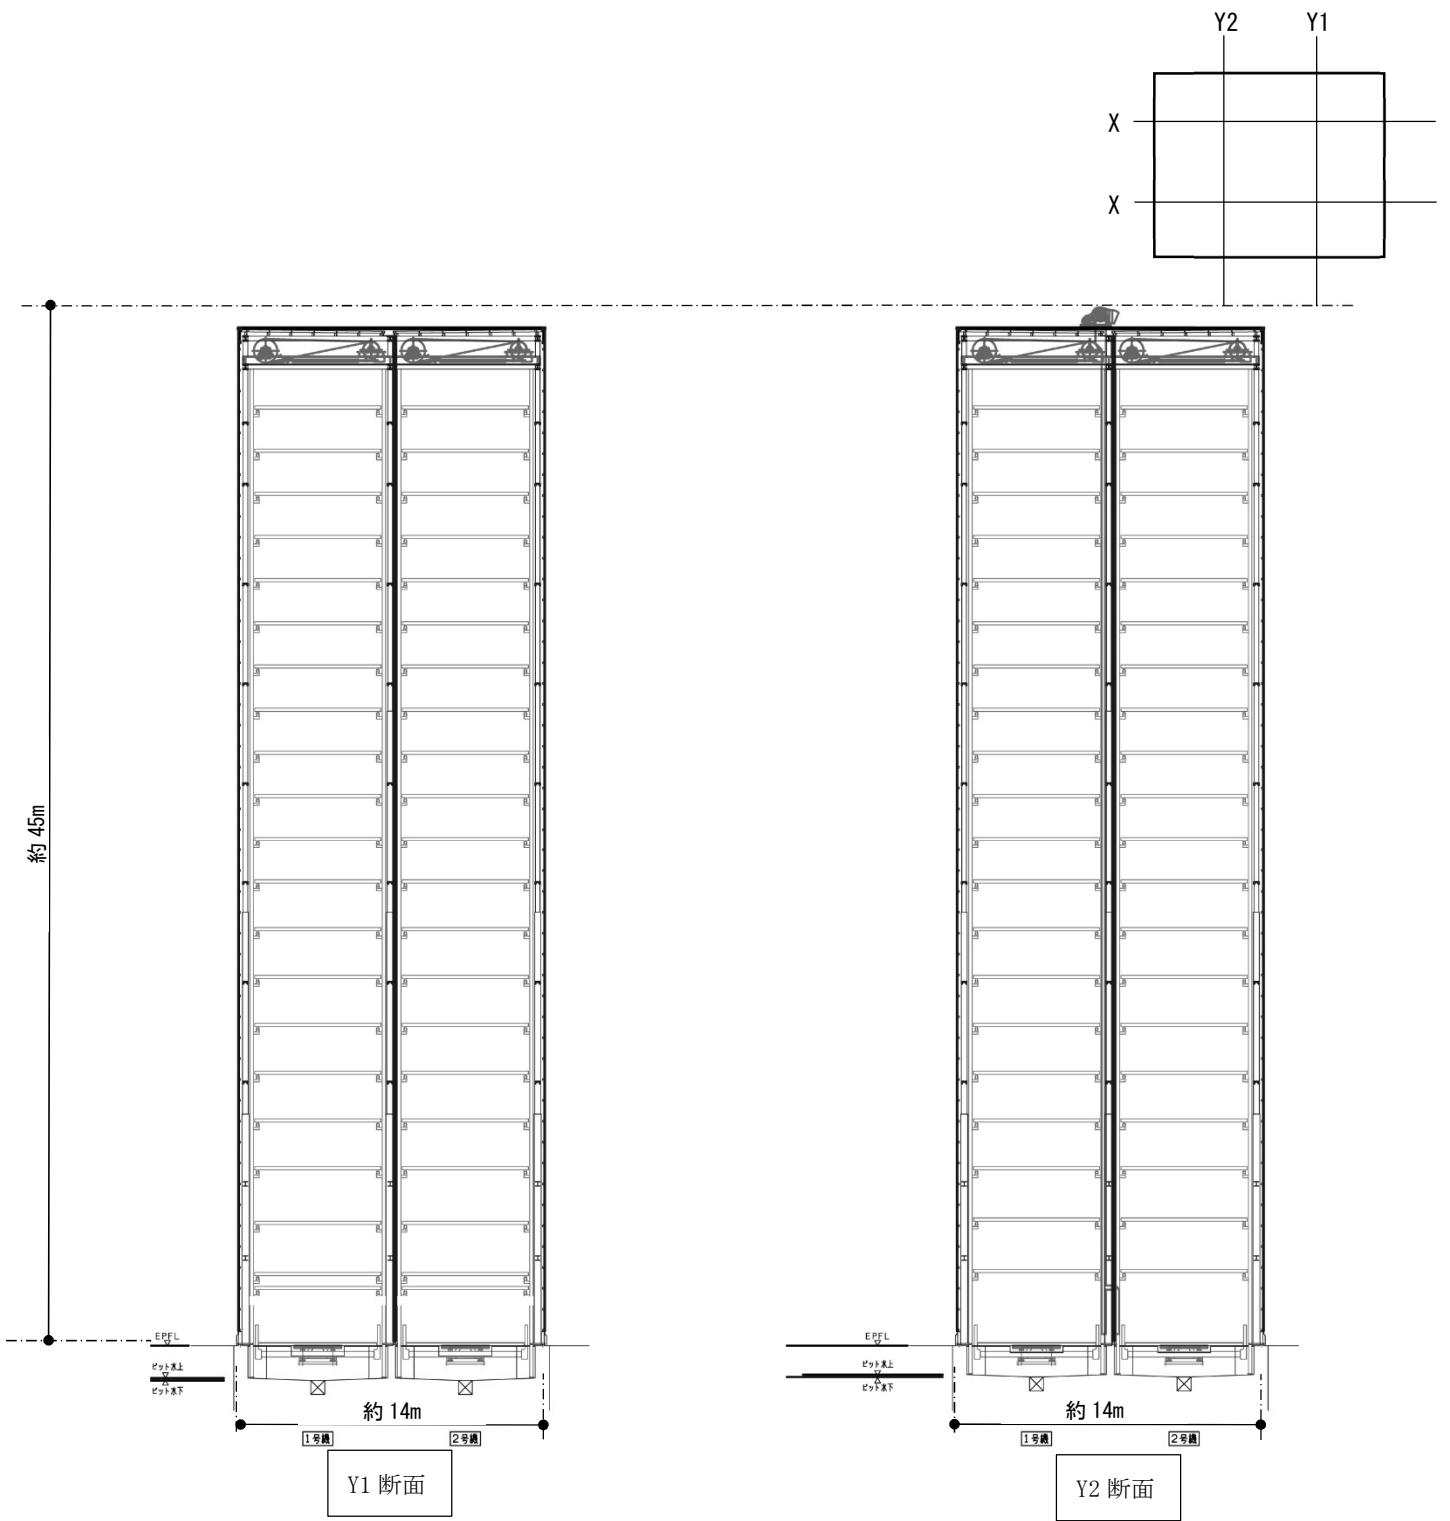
(3) タワーパーキング断面図 (Y 断面)
